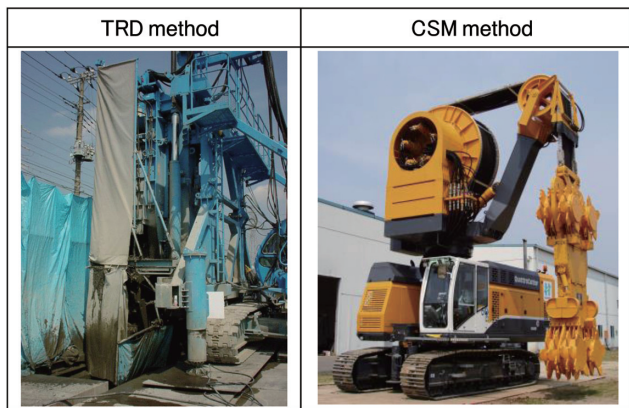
TRD 工法及び CSM 工法の施工機械⁴⁾
